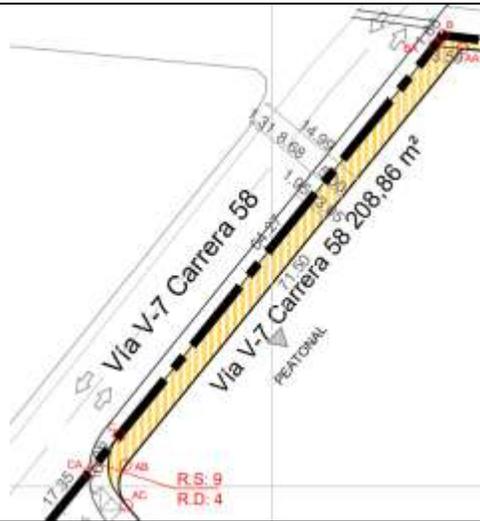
Plano de Espacio Público del planteamiento urbanístico del PPRU-CC
